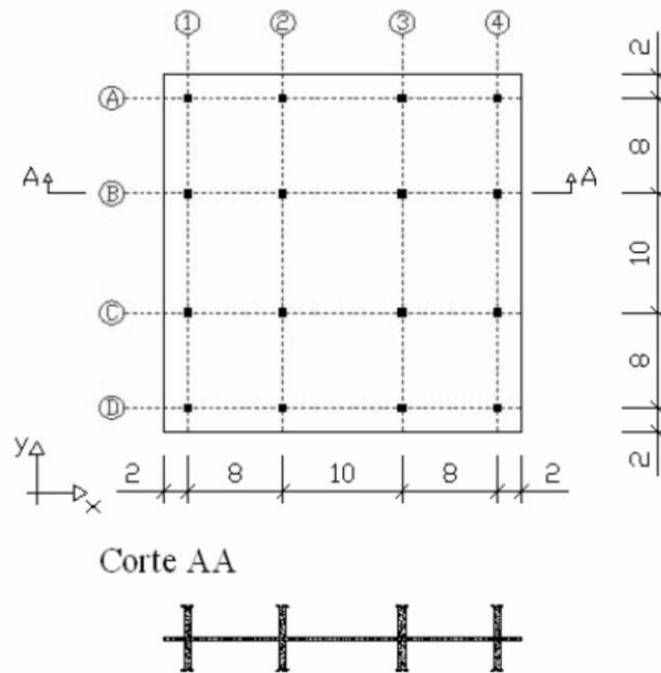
Planta do pavimento, medidas em metro (LORENCI, 2010).
